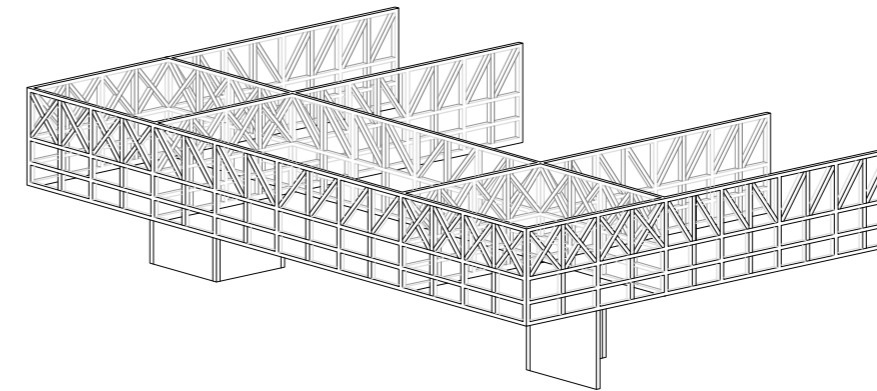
Esquema do sistema construtivo do primeiro piso.
